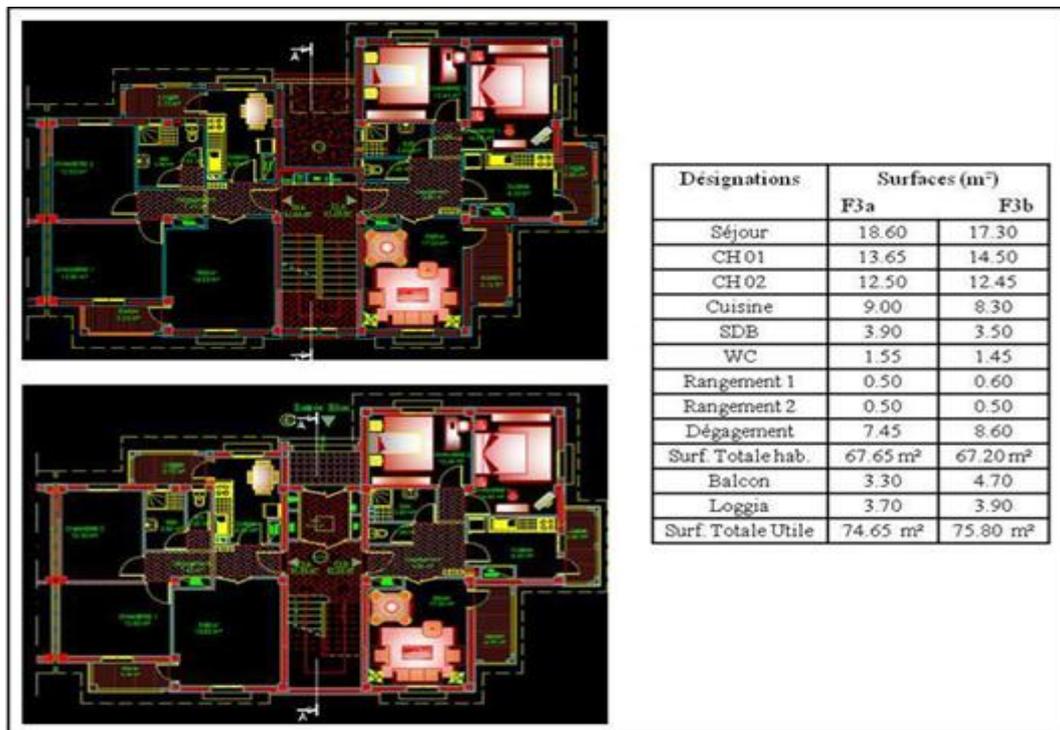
plans du bloc B. Source : (ferradji 2017)
